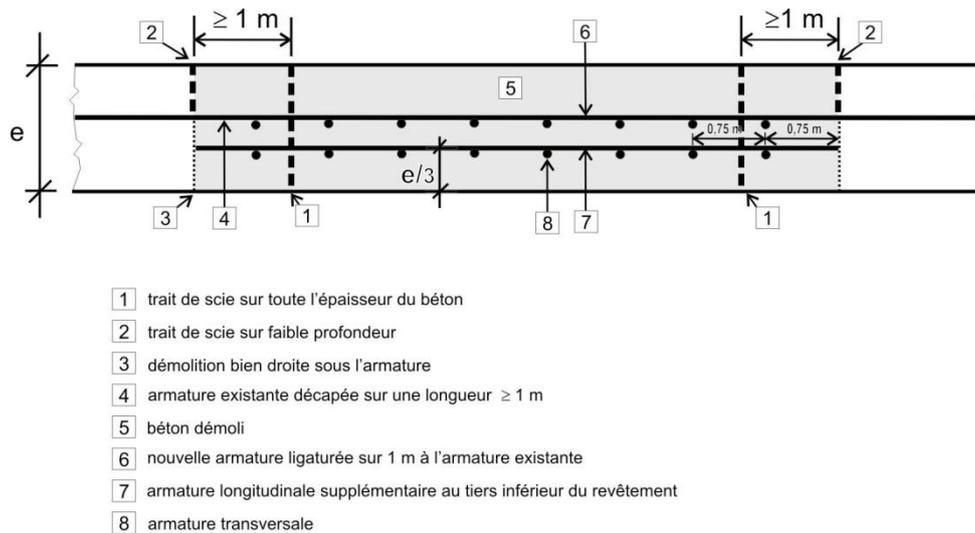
Rétablissement du ferrailage dans une réparation en béton armé continu.
